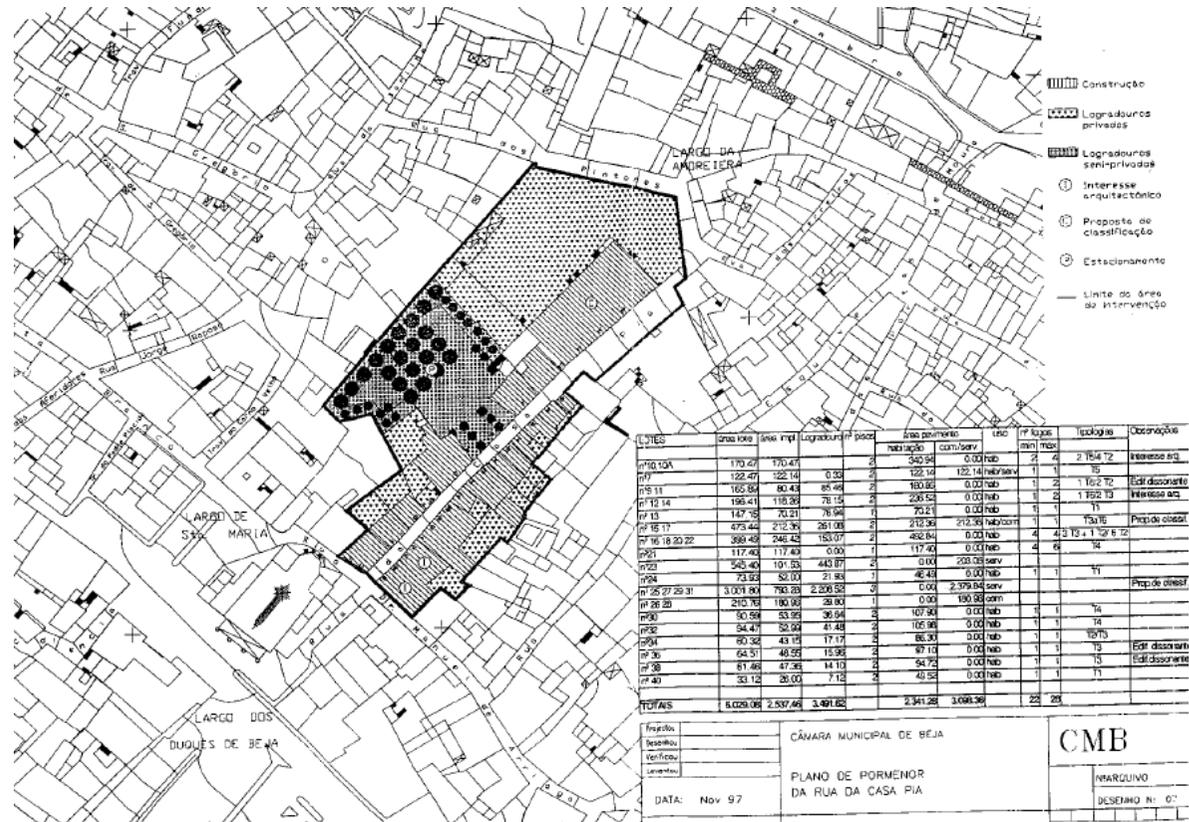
Plan de Pormenor de Rua Casa Pia, año 2000. Planta de Síntesis
